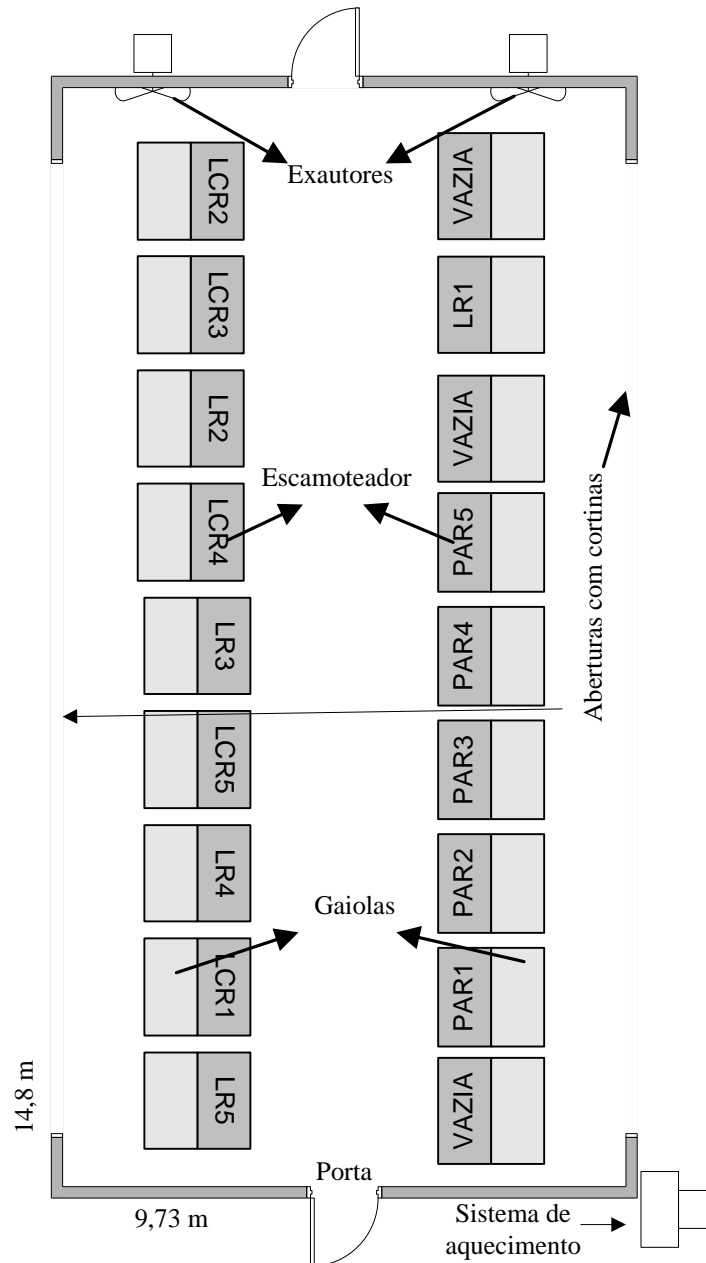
Planta baixa da sala e distribuição dos tratamentos
